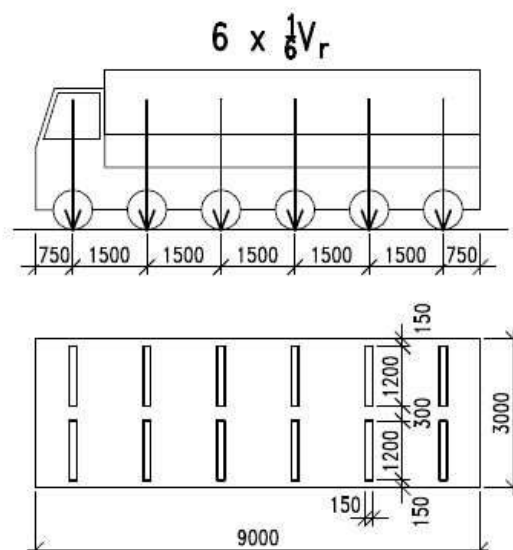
Normální zatížitelnost - Schéma zatížení konstrukce dopravou, vč. roznášení kolových tlaků, poloha pro stanovení maxima na okraji konstrukce
